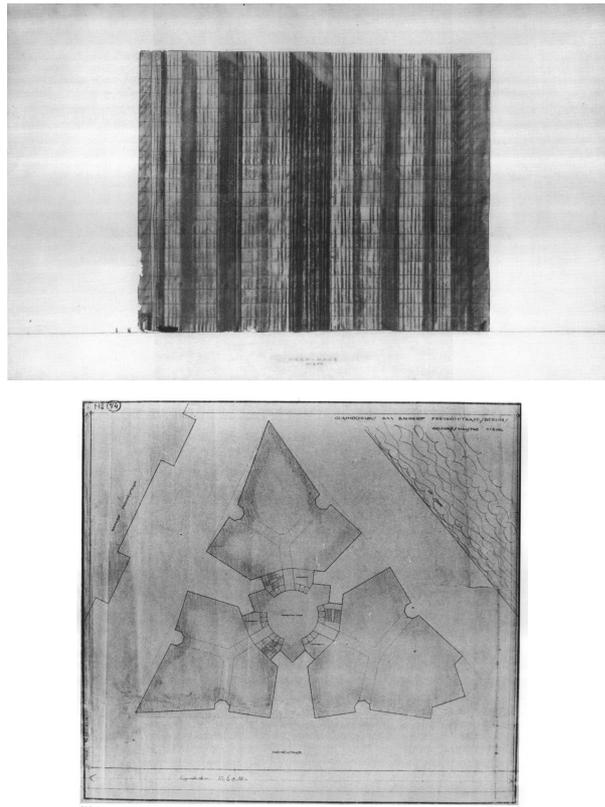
y 18. Alzado y planta general del Rascacielos de Cristal de Friedrichstrasse, 1921, Mies van der Rohe.
